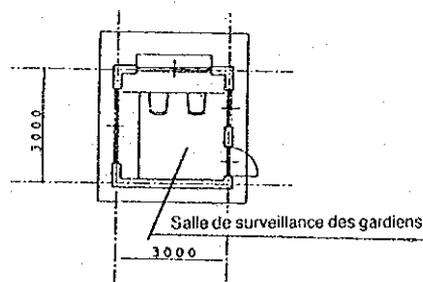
Plan de la cabine des gardiens 9,0 m²
